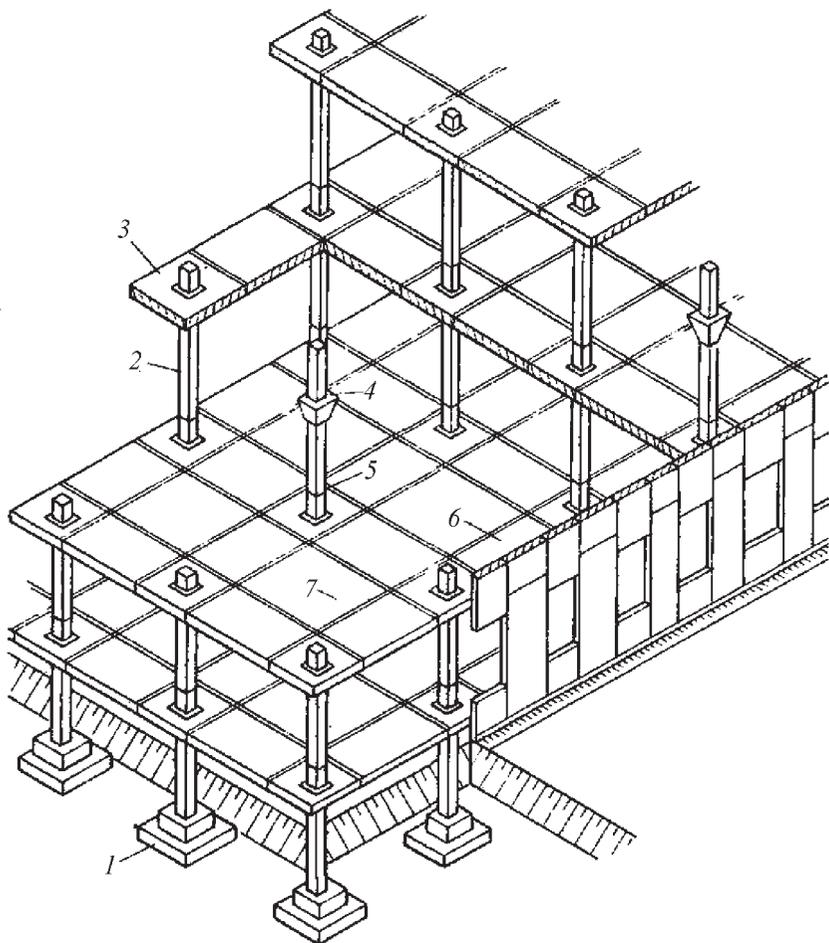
Каркас с безбалочным перекрытием капительного типа:
